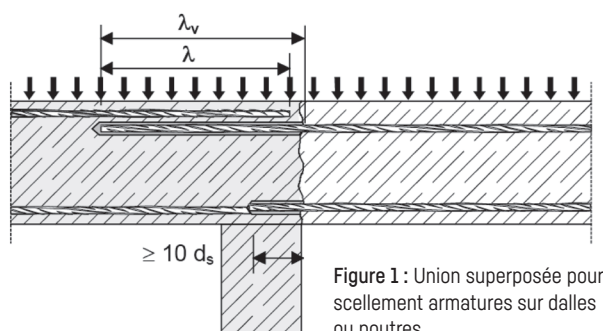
Union superposée pour scellement armatures sur dalles ou poutres.
